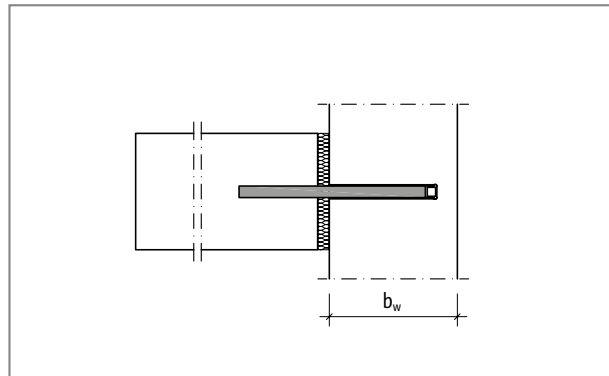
Schöck Dorn tipo LD: spessore minimo dell'elemento di una parete o di un pilastro
